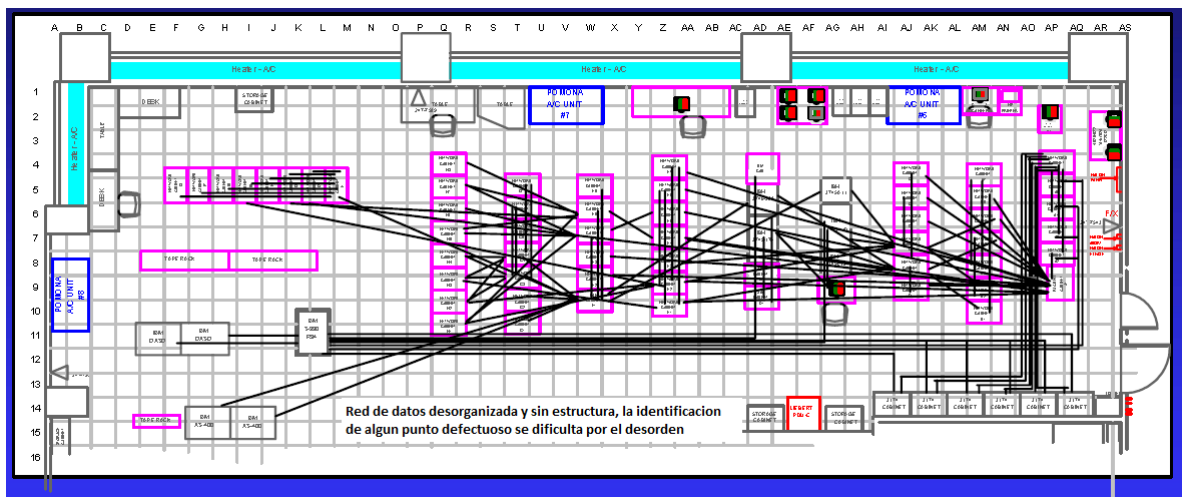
Vista de un Centro de Datos sin Cableado Estructurado
